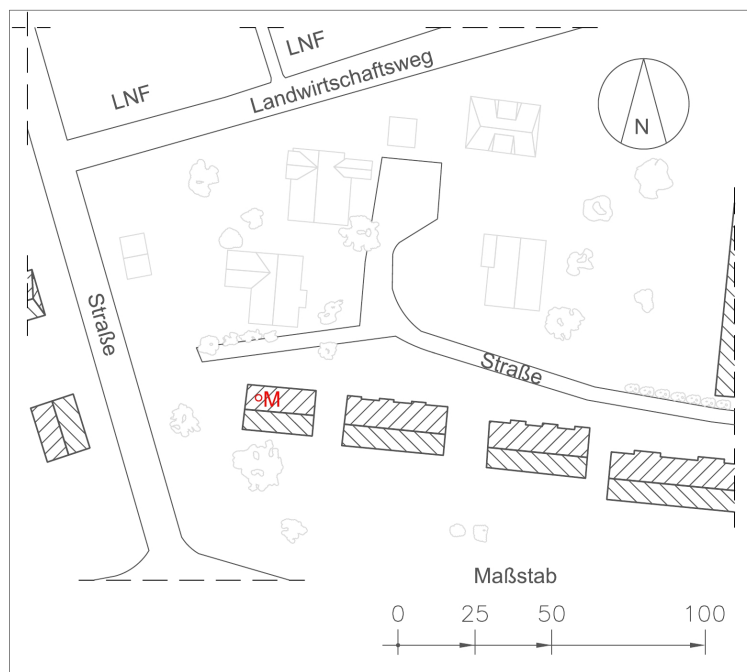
Grundriss des Untersuchungsraums der Wohnung in Weimar
